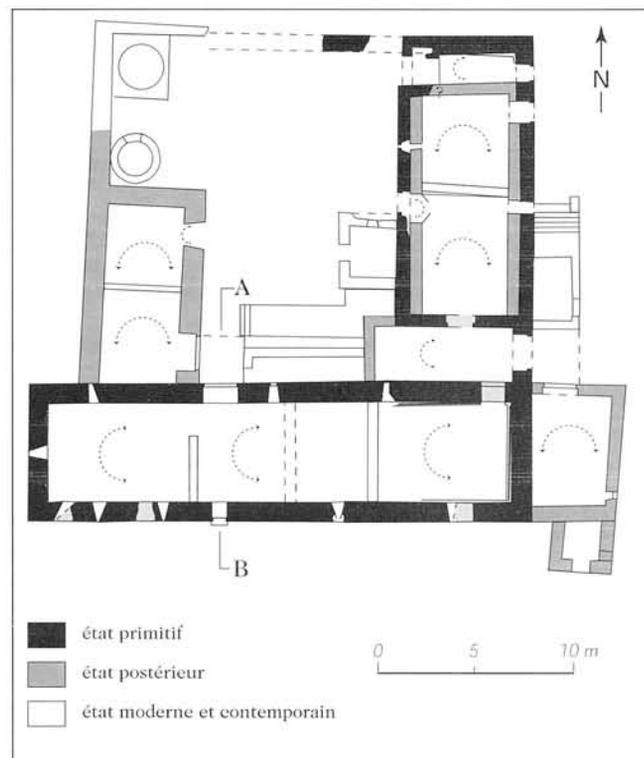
LIMANS, hameau des Ybourgues. Plan du niveau 1 (rez-de-chaussée).
